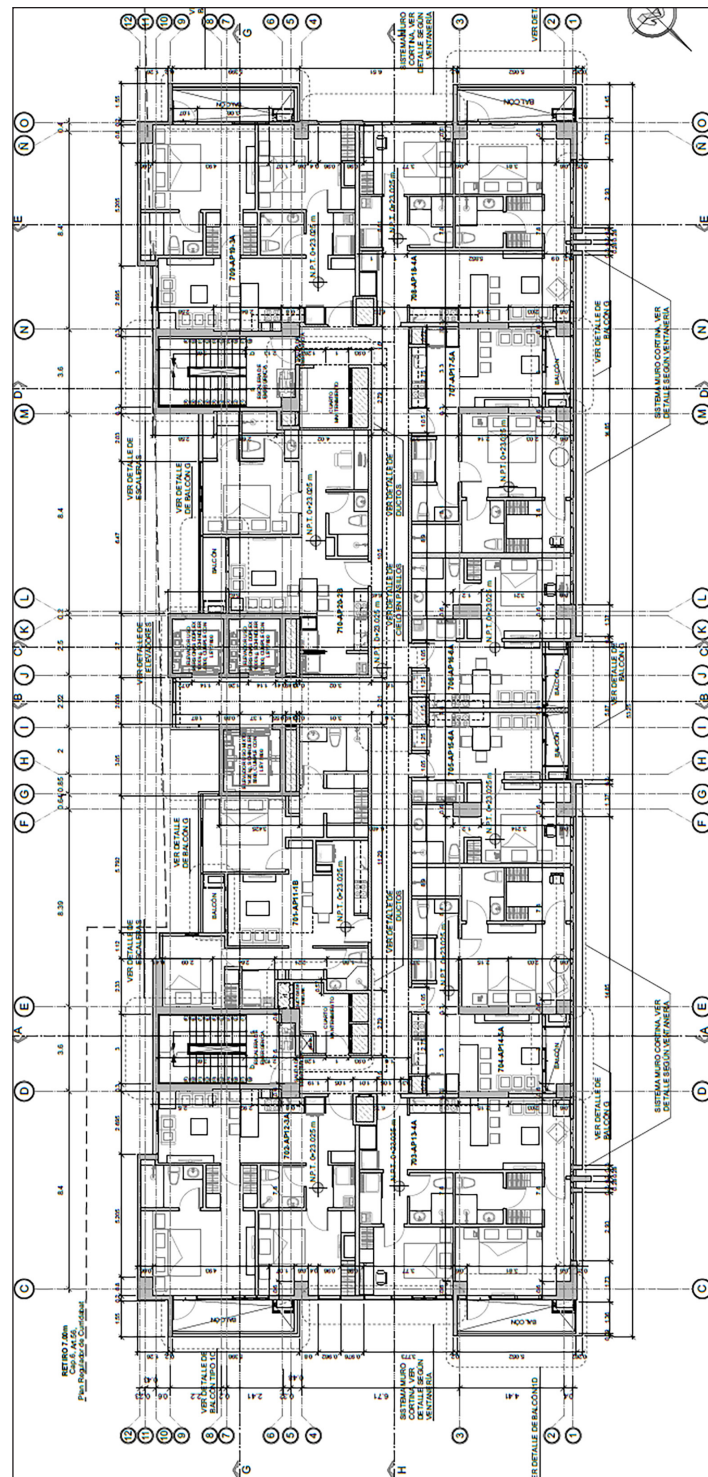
Planta arquitectónica del nivel 7, 8, 9, 10 y 11 (apartamentos) del edificio TLL.
